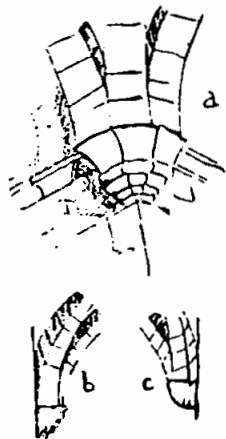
Ménsulas de la bóveda del piso bajo de la torre. (Su situación se señala por las letras en el plano).
